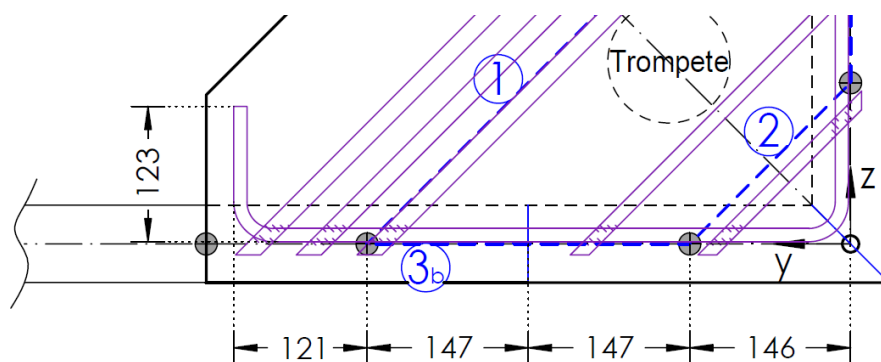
Verankerungslängen Zugstrebe Nr.3b
